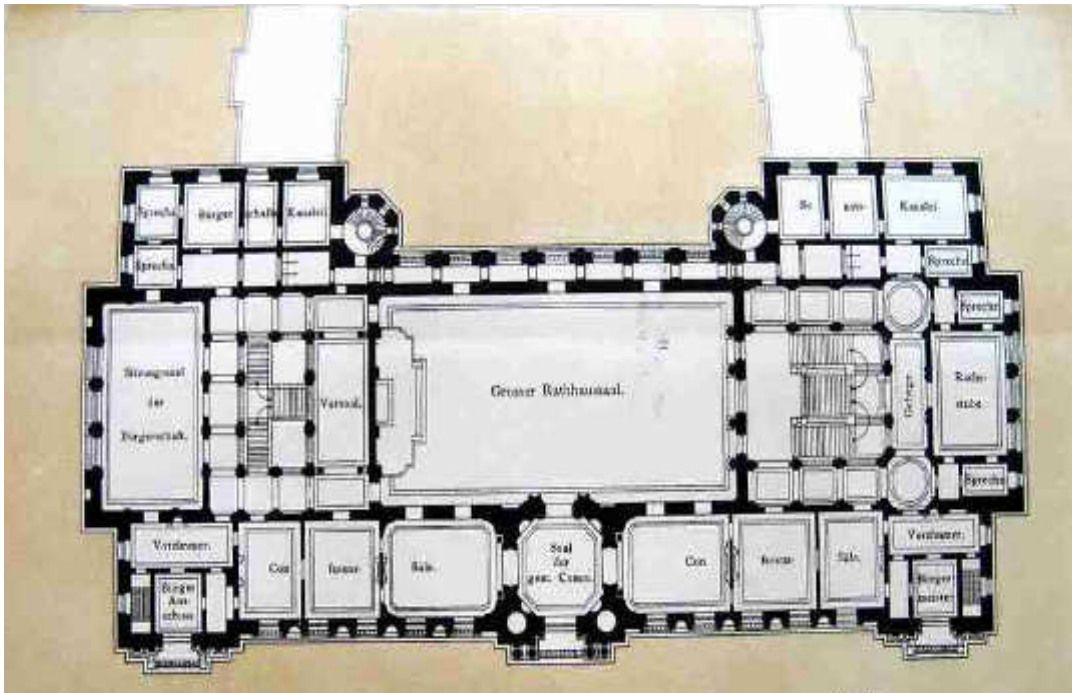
Grundriss Hauptgeschoss Entwurf Viribus unitis 1880.
